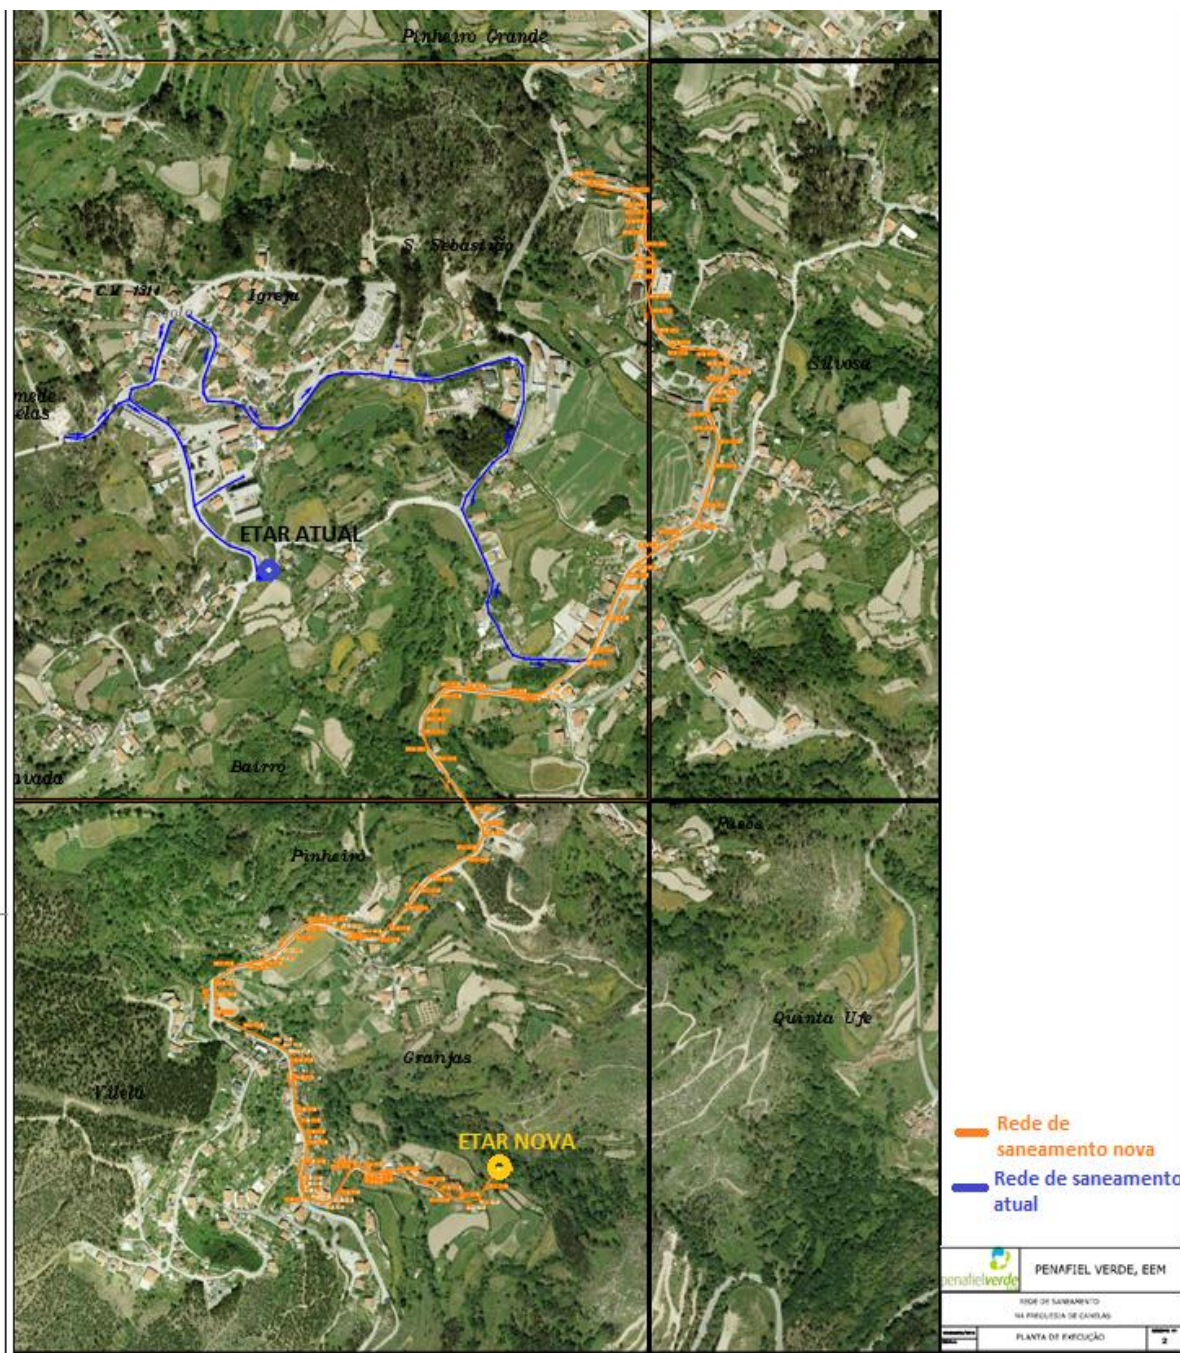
Planta de execução da rede de saneamento da freguesia de Canelas
